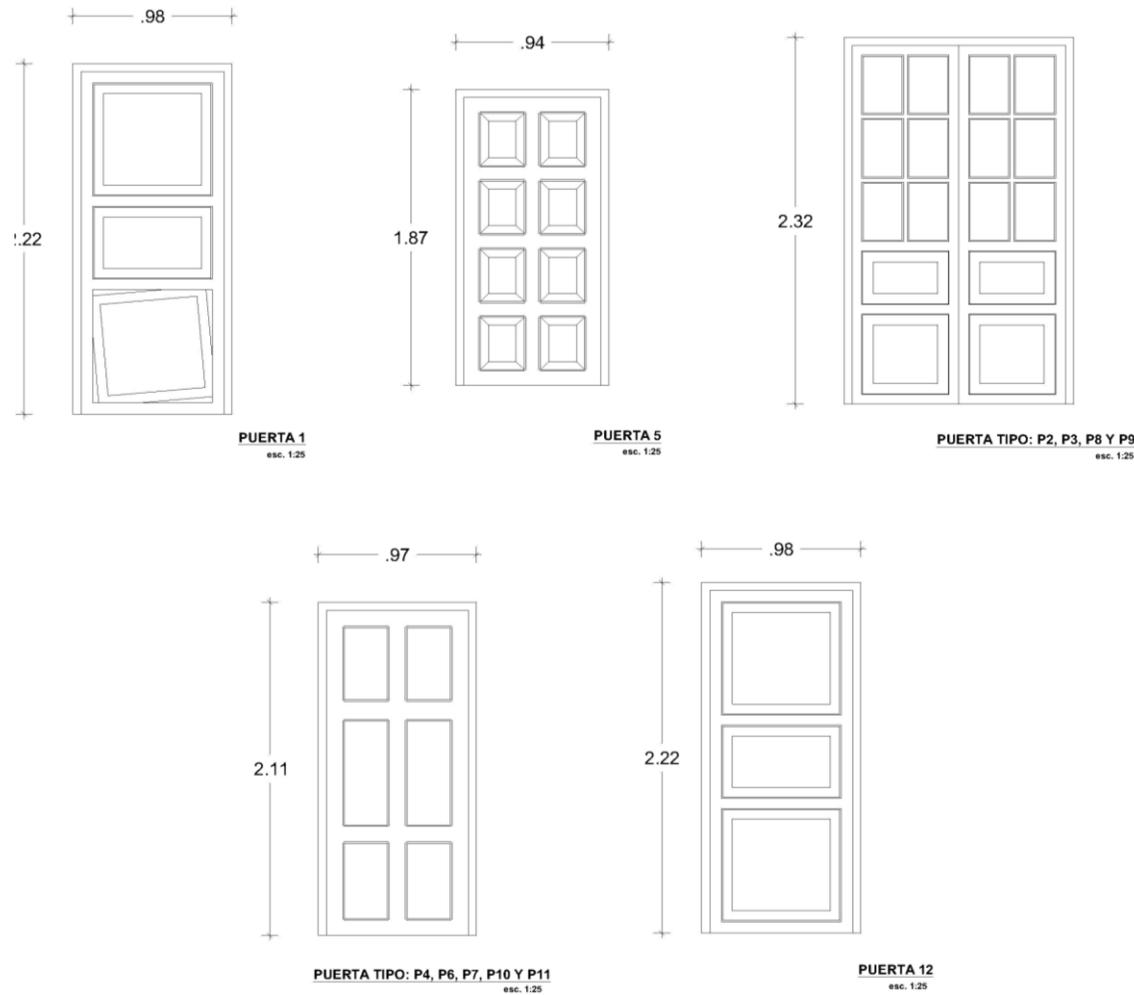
Detalles de forma y dimensión de carpinterías de puertas, Fuente: Elaboración Propia
